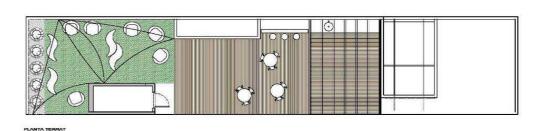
Planta arquitectónica de primera y segunda intervención de proyecto MENSALUS 2011-2015
